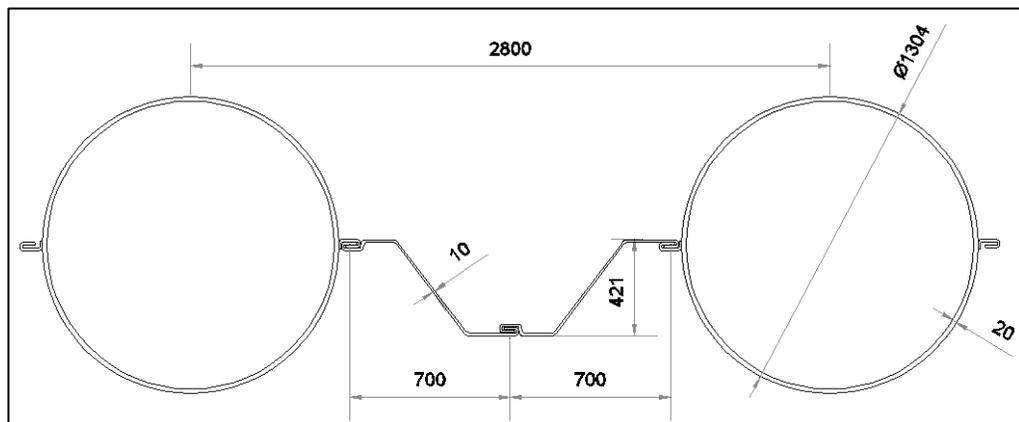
Sección tipo de la tablaestaca a utilizar en la pared exterior, del sistema combinado de doble muro.
